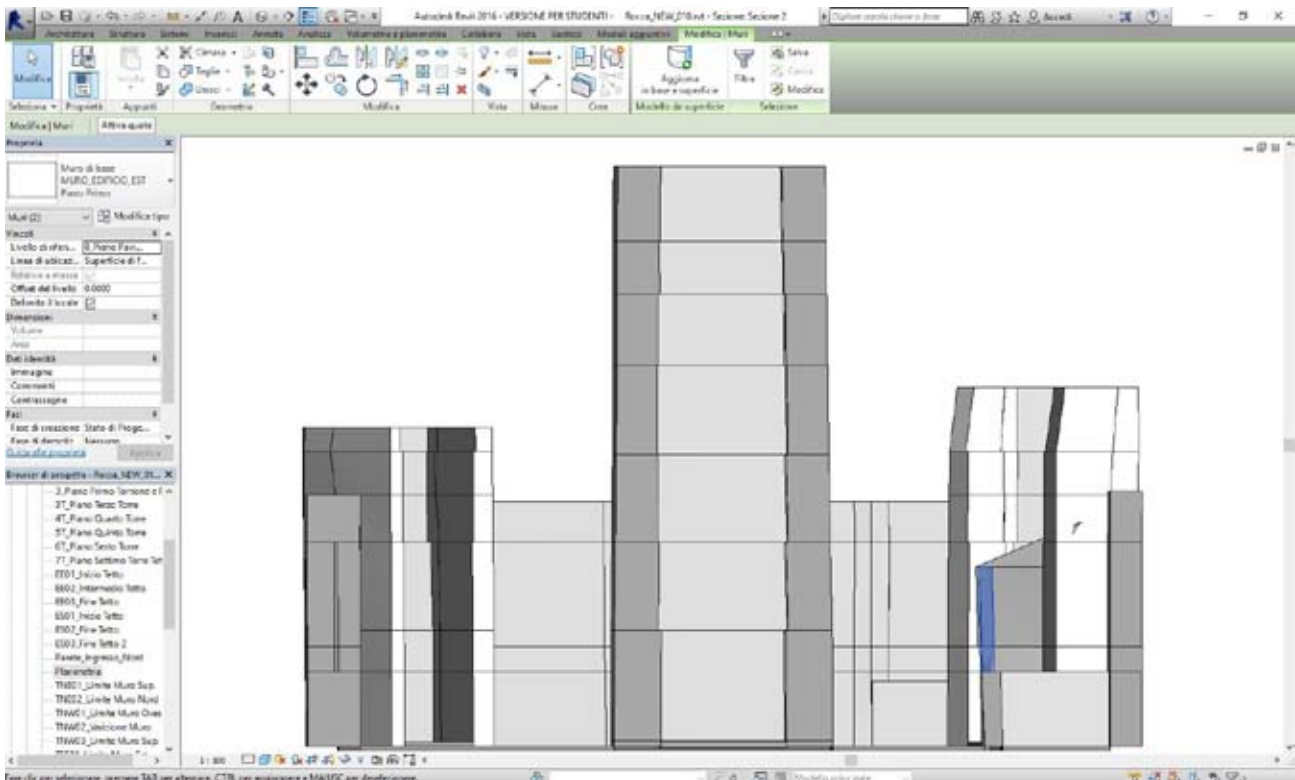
Vista di sezione dei muri da superficie - Audodesk Revit 2016.
